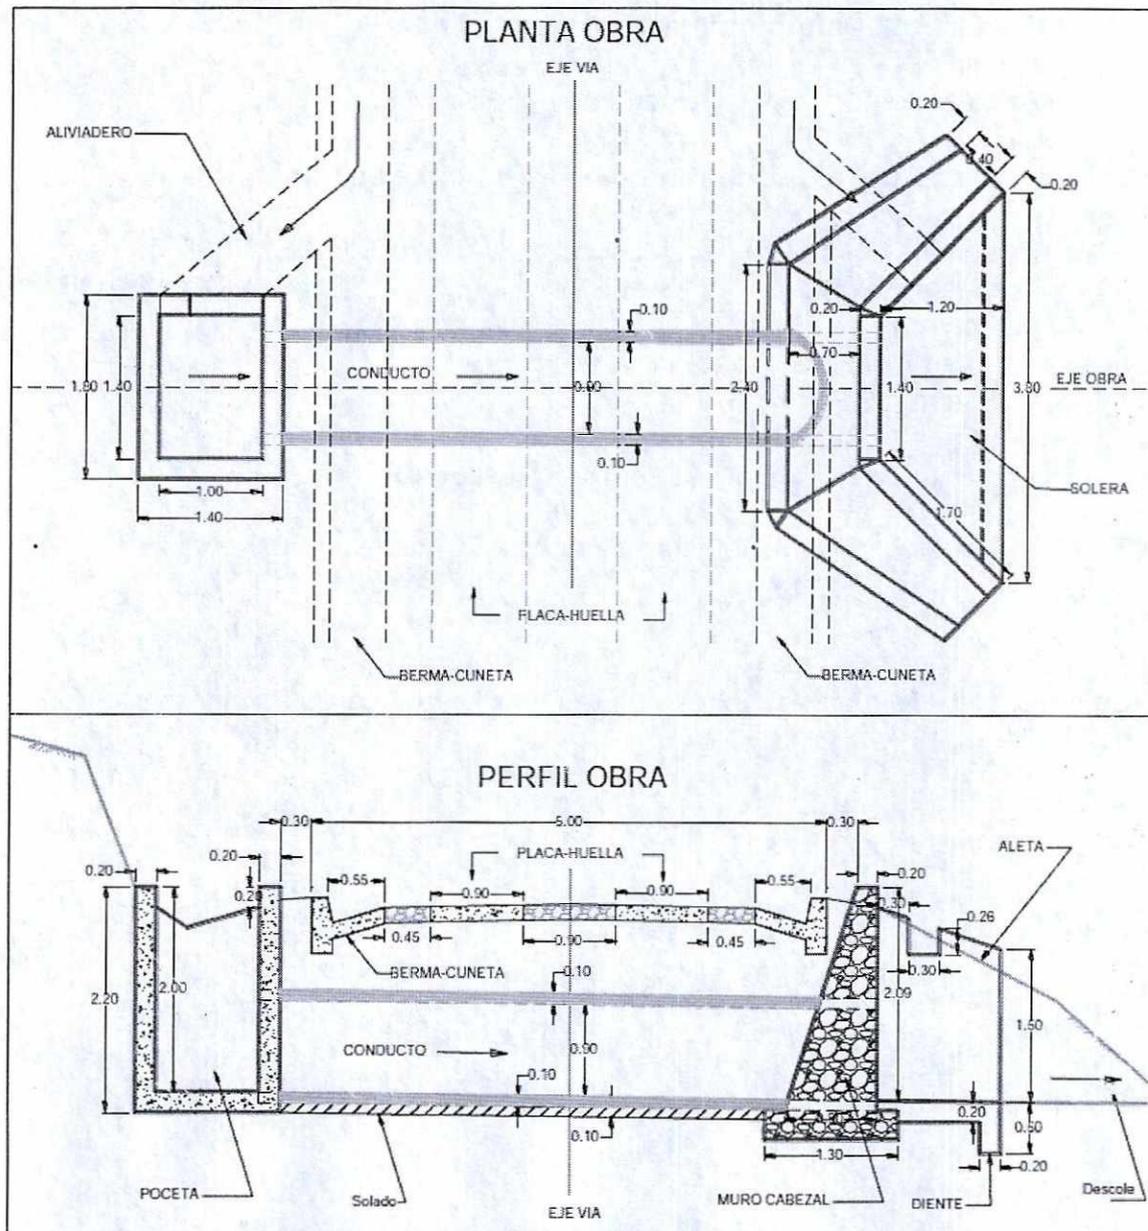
Detalle en planta y perfil de la alcantarilla tipo.
